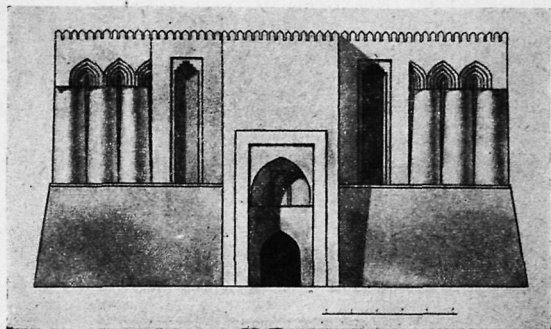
Овлияли-кёшк. Реконструкция фасада.
